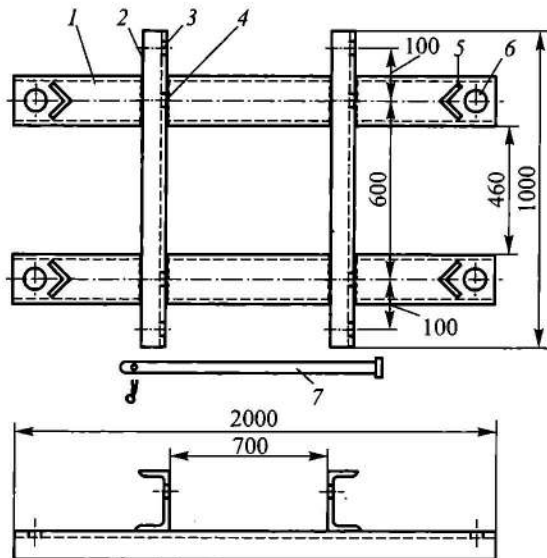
Конструкция швеллерного «фундамента» с креплением в грунт:
